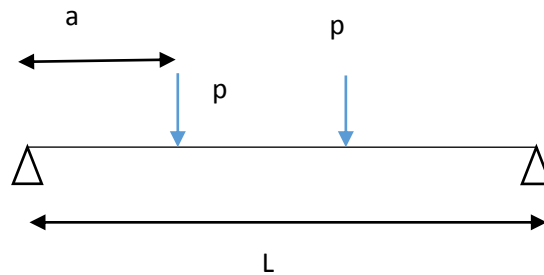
déformation du poutre sous l'effets des galets sur seul travée
